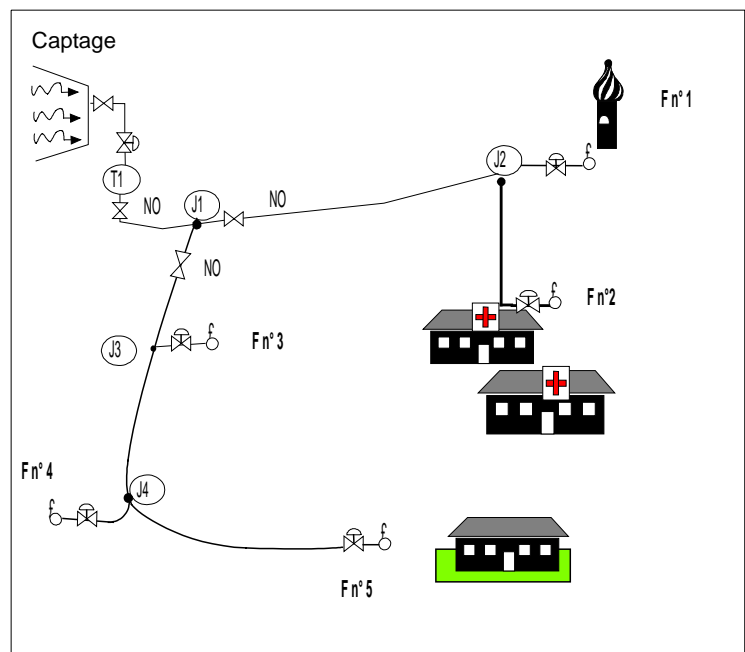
plan de vannage du réseau d'Aloua (hors vidanges et purges d'air)
